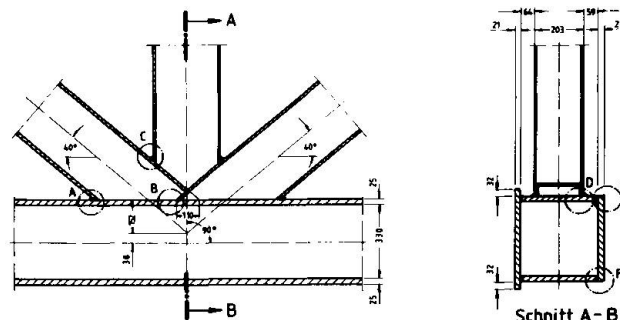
Die ursprünglichen Schweißnahtdetails der Brücke
